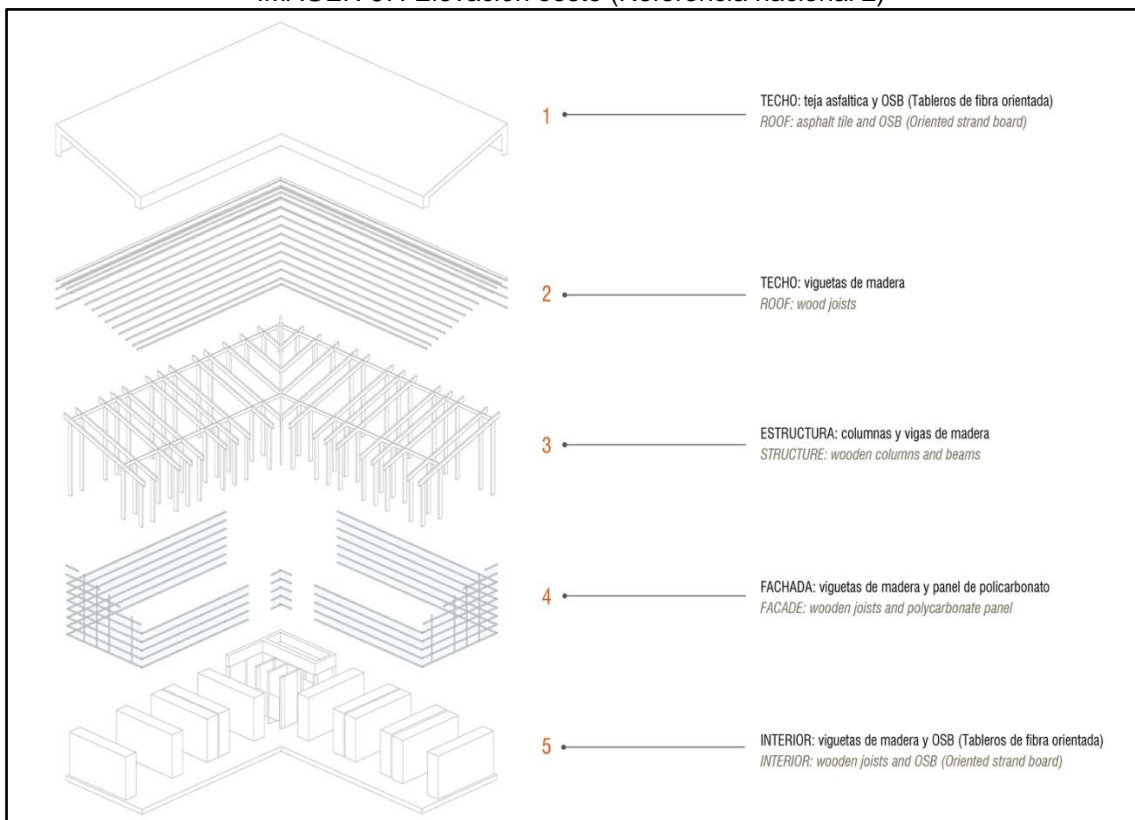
Sistema constructivo (Referencia nacional 2)
